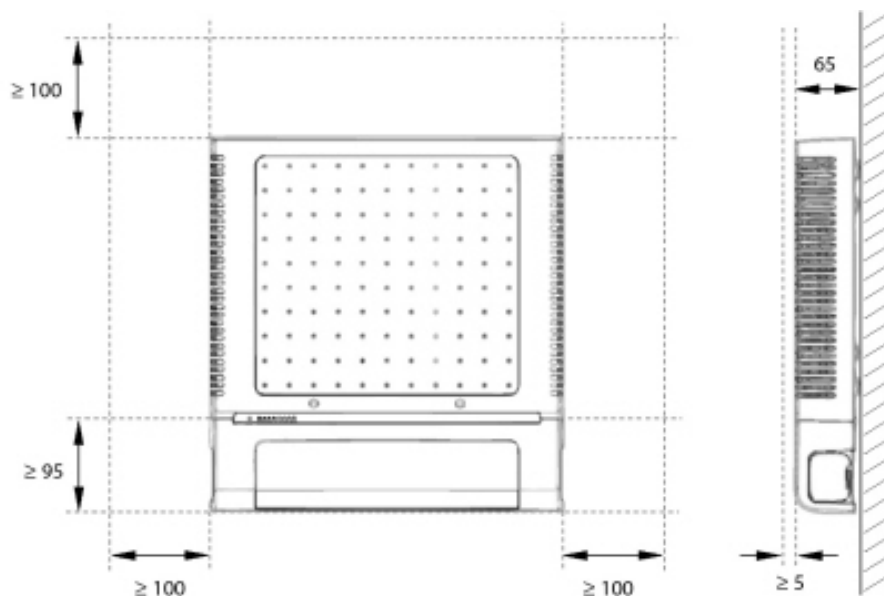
Minimale afstanden voor wandmontage (voorpaneel naar onder gericht)
